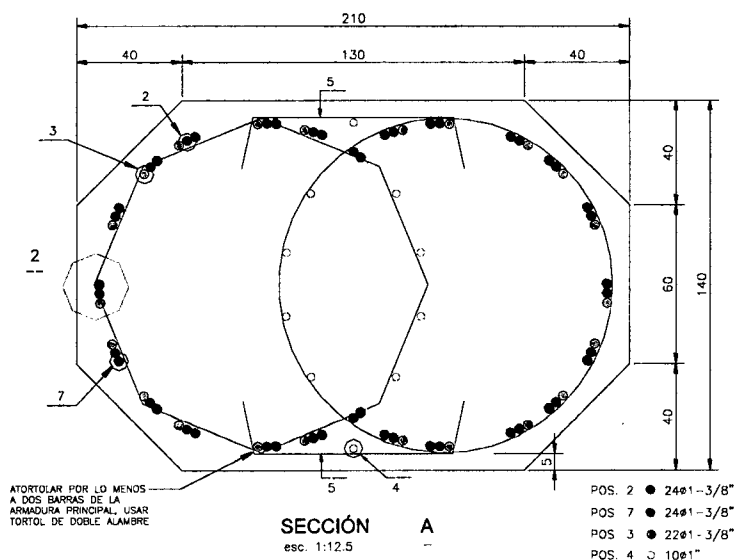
Detalle de distribución de acero de columna y viga cabezal.
